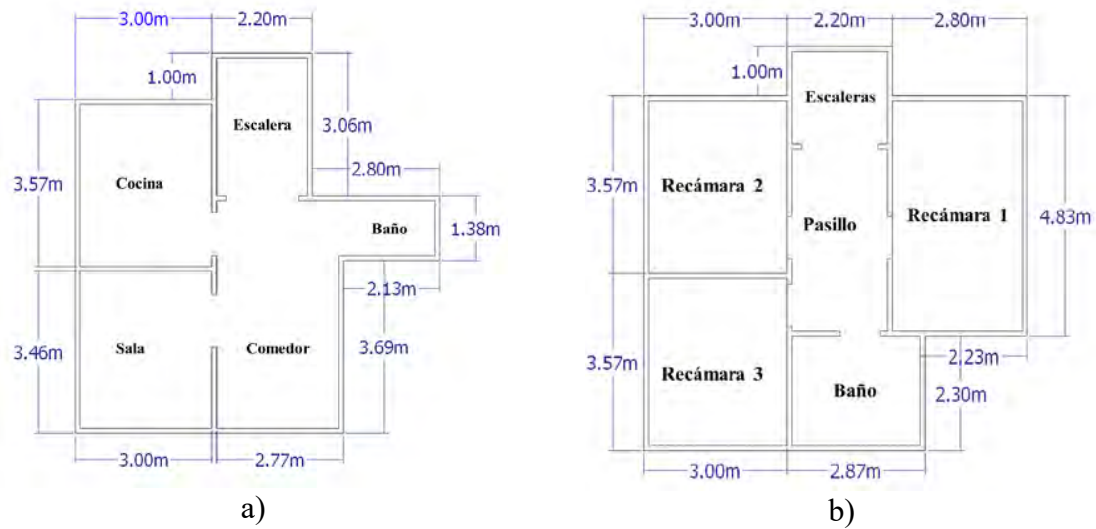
Planos de la vivienda en: a) planta baja, b) planta alta.
